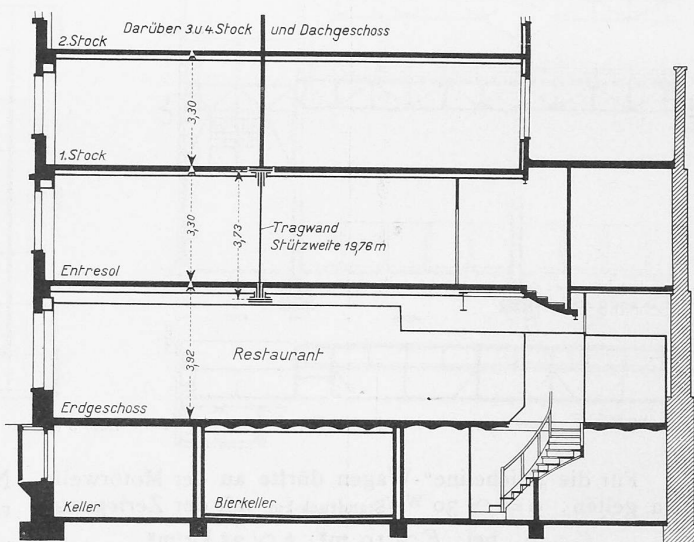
Gebäudeschnitt mit Wandträger über dem Restaurant. — 1 : 200.
